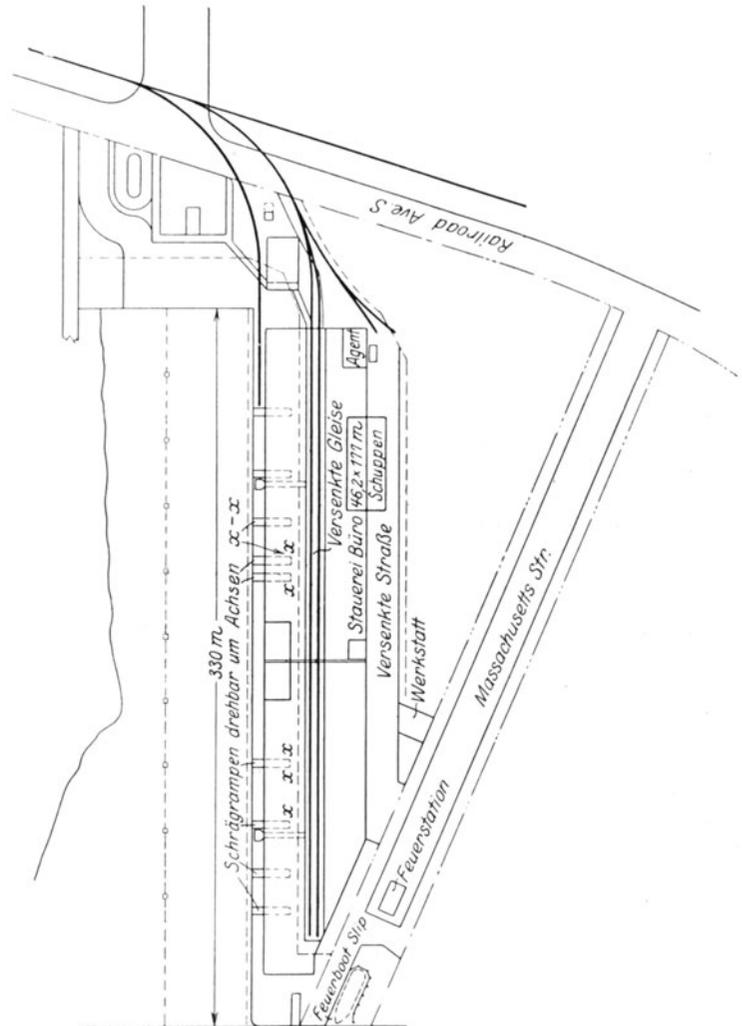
Pacific-Pier. Allgemeiner Lageplan und Bahnzuführung.
